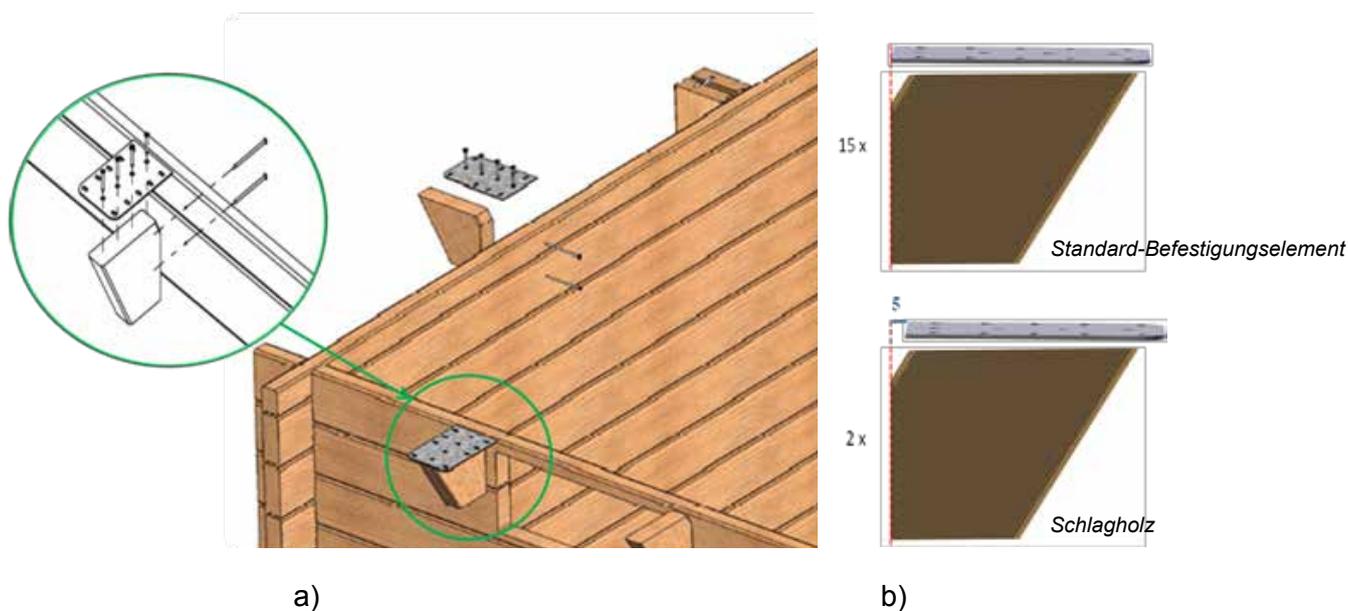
a und b - Installation der Metallplatten auf den Holzkeilen des Handlaufs
